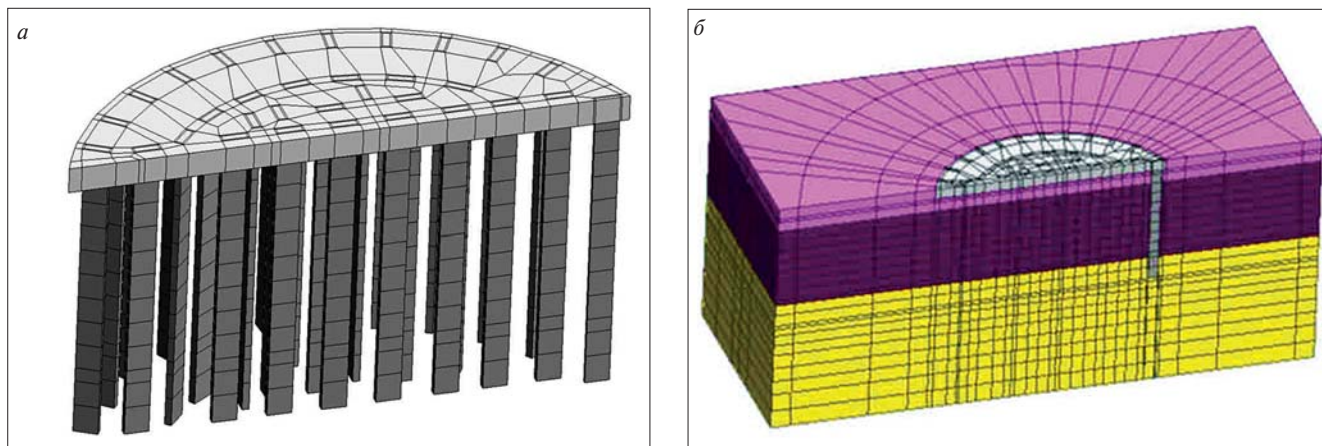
Расчетная модель для расчета фундамента методом конечных элементов: а – фундамент; б – фундамент и грунты основания
